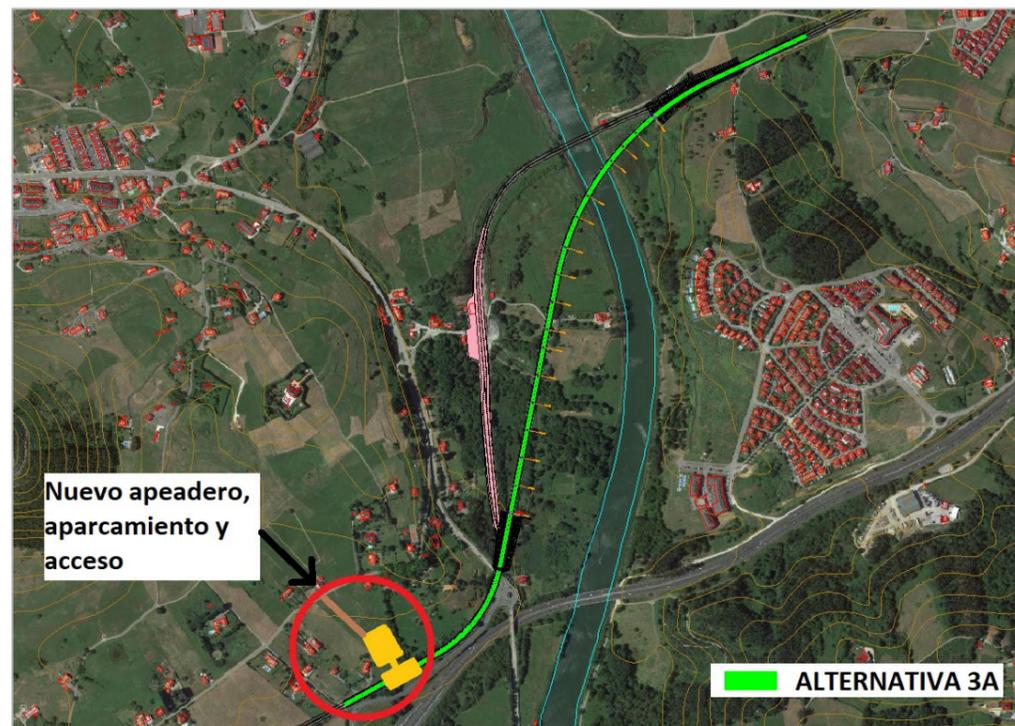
Trazado en planta de la alternativa 3A. Fuente: Istram
